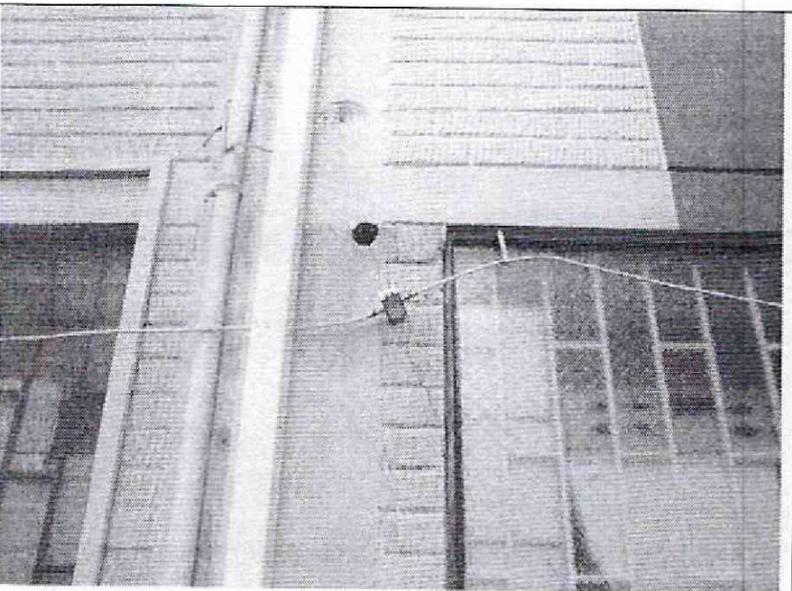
Fisura en muro de fachada interno de primer piso.
